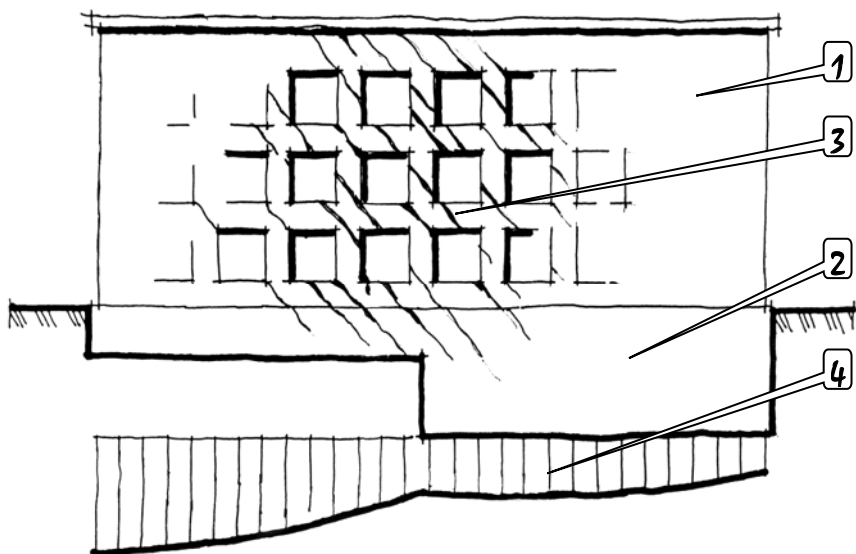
Пошкодження при неправильному влаштуванні фундаментно-підвальної частини будівлі: 1 – нова будівля; 2 – фундаментно-підвальна частина будівлі; 3 – зона появи і розвитку тріщин; 4 – епюра осідань фундаментів
